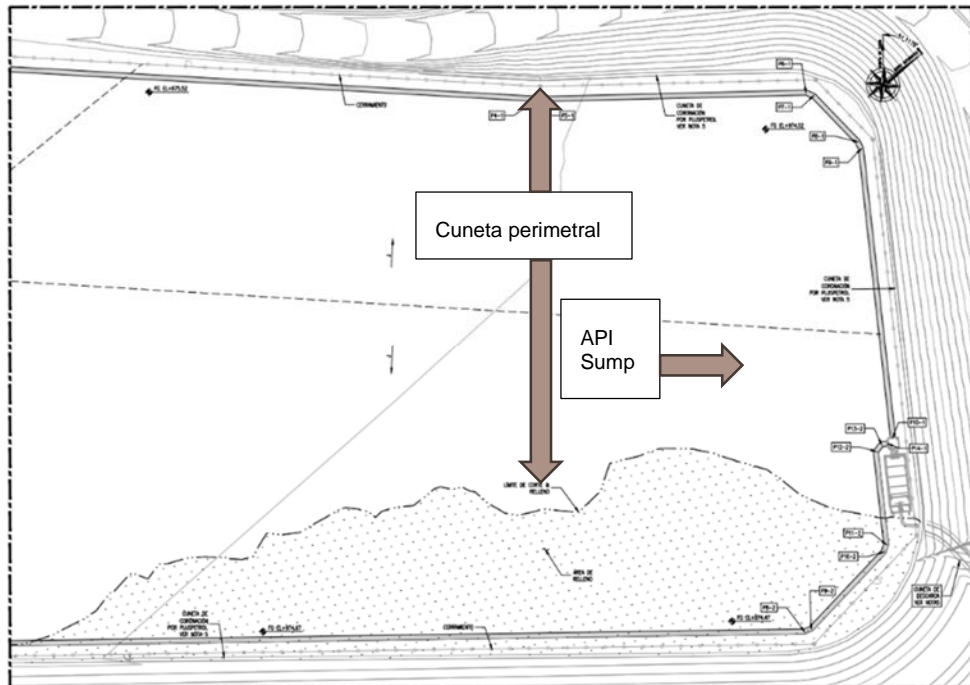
Cunetas perimetrales y ubicación de Trampa API
